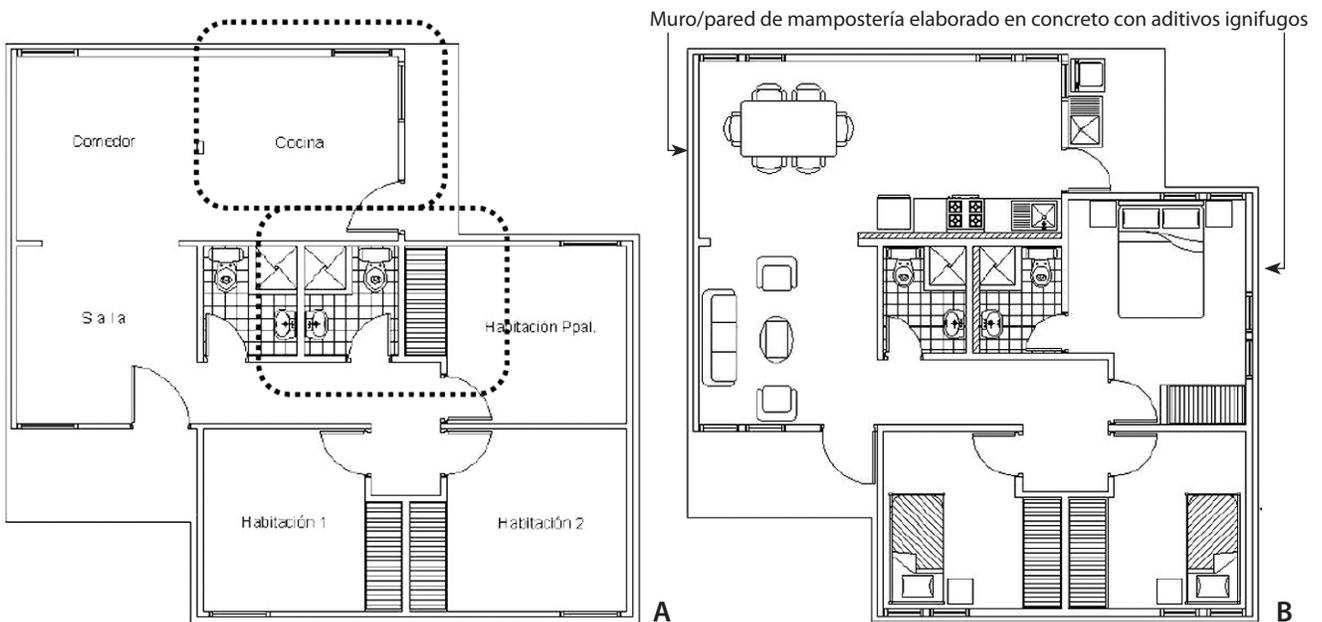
(A) Planta original del Modelo 4, Vivienda continua tipo urbana (85,50 m²) de CVG Proforca; (B) Planta rediseñada con un área construida de 93,13 m².
